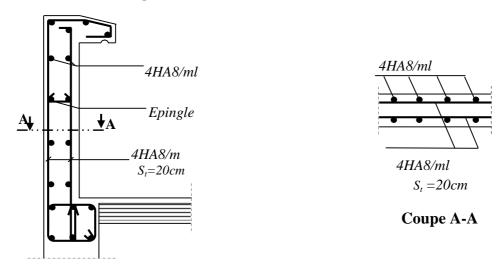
Schéma de Ferraillage de l'acrotère
